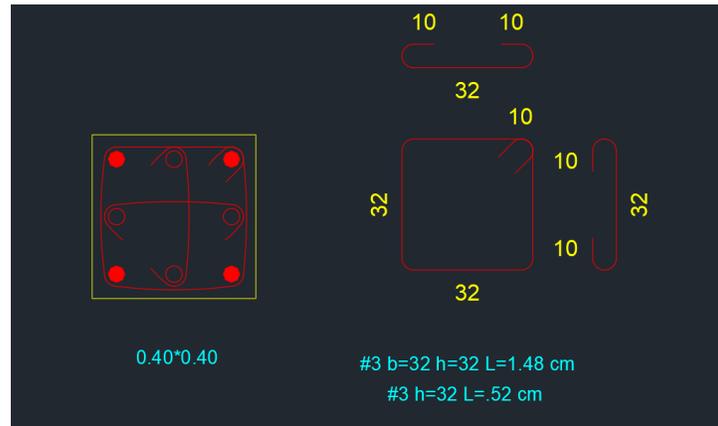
Sección columnas pequeñas (fuente: planos estructurales Edificio Fourvière)
